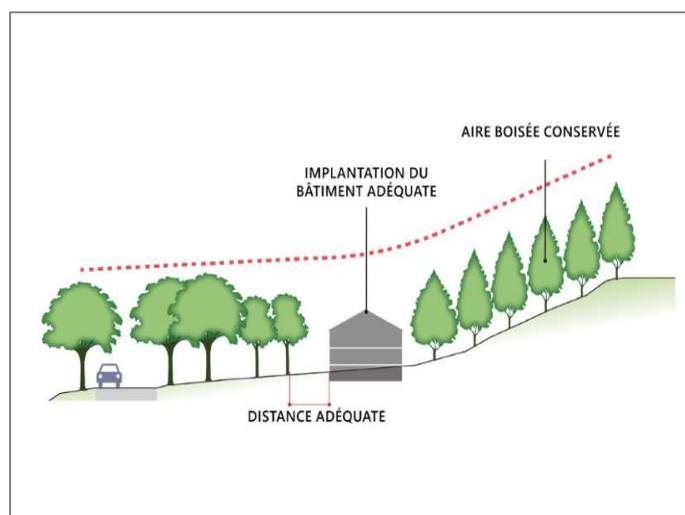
L'implantation des bâtiments s'adapte à la topographie naturelle du terrain afin de sauvegarder le plus possible la végétation existante et restreindre au minimum les déblais et remblais autour du bâtiment.
